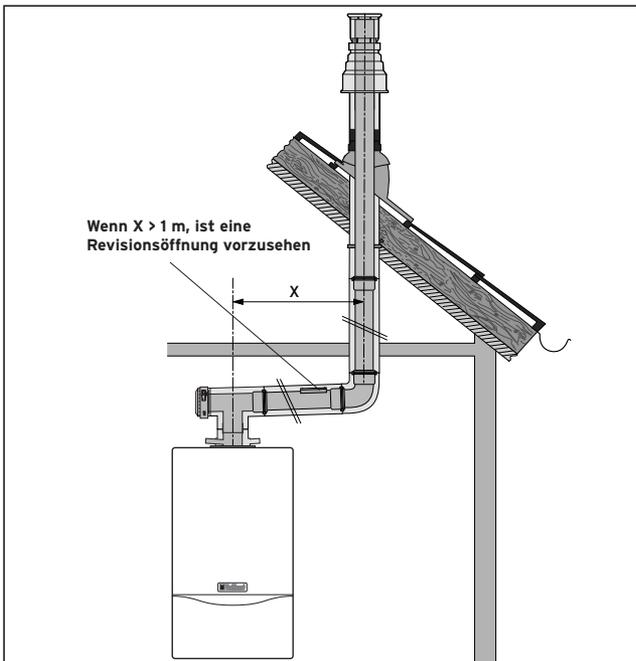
Montagebeispiel Senkrechte Dachdurchführung
